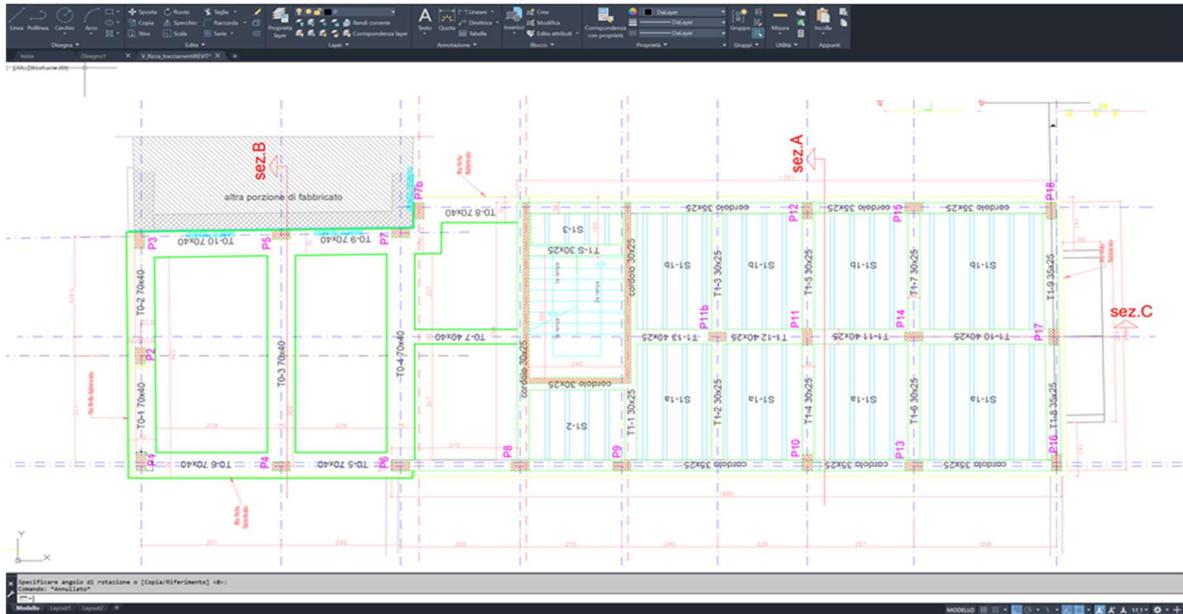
Prima fase di elaborazione grafica con identificazione di un layout strutturale (software AutoCAD)
